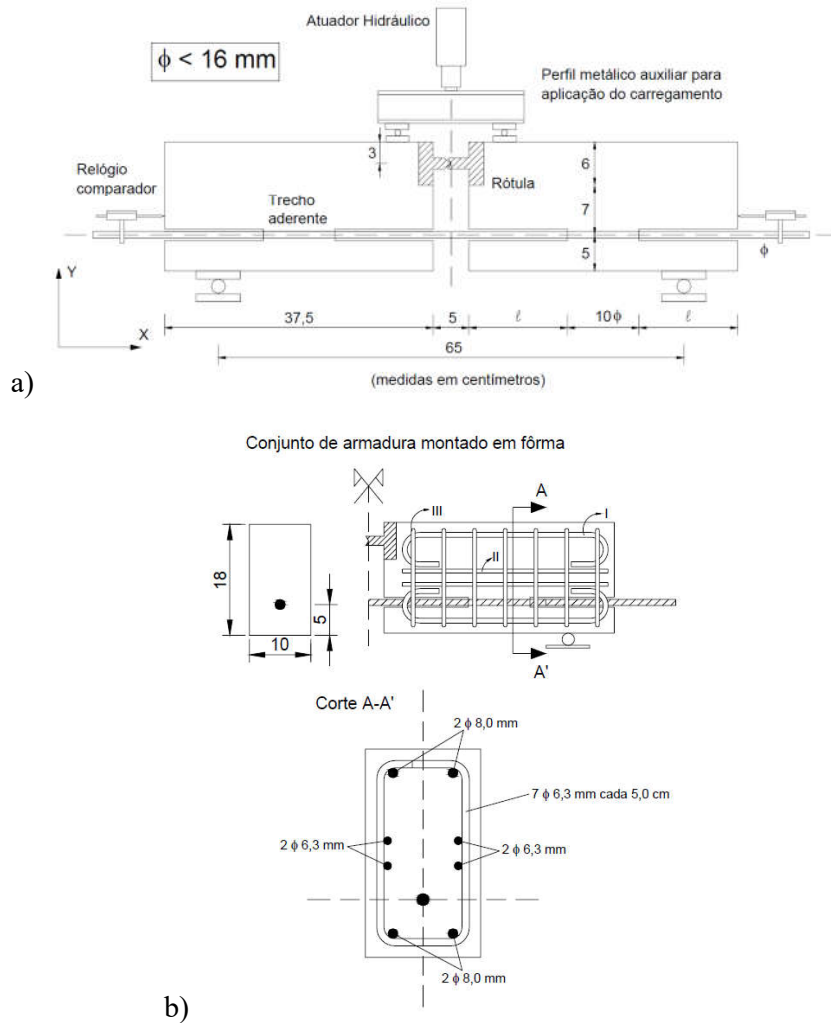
Esquemático do *Beam Test*: a) dimensões da viga; b) detalhamento da armadura (EN 10080, 2005).
